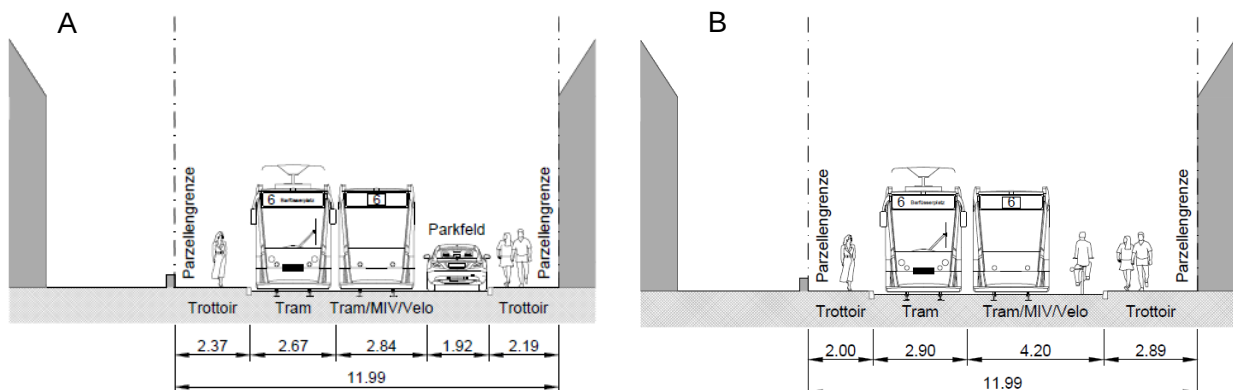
Heutiger [A] und projektierte [B] Strassenquerschnitt mit Flächenaufteilung (Austrasse Nr. 81 und 94)
